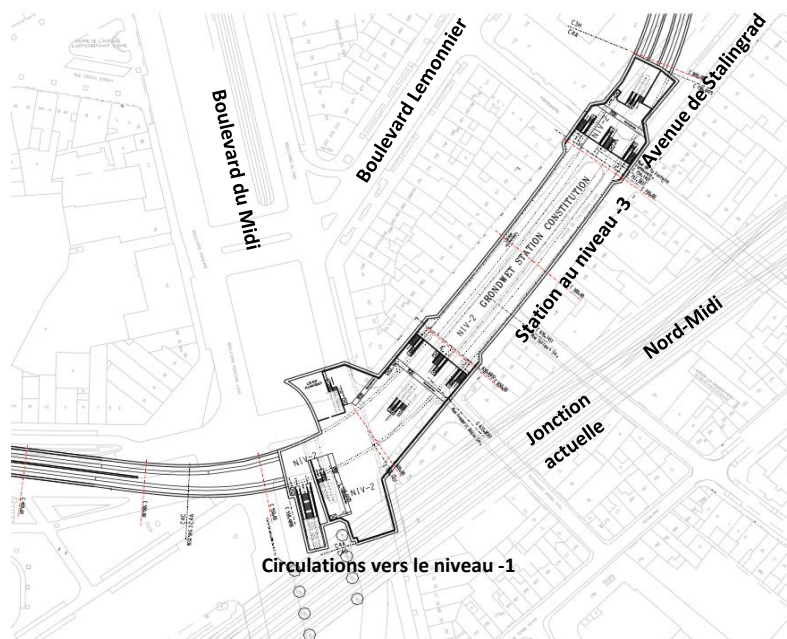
Vue en plan de la nouvelle station de métro – niveau -2 Source : ADT, d'après plan Bruxelles Mobilité
